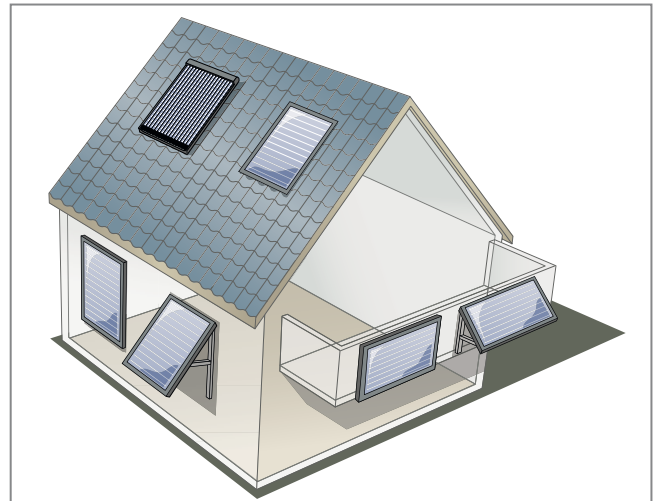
Kollektormontage auf dem Dach und an der Fassade/Balkon
